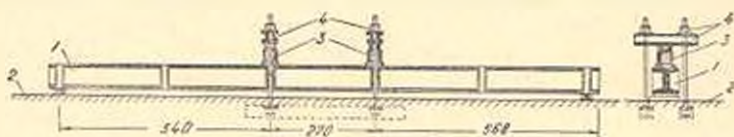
Схема испытания струнотонной балки на изгиб на стенде;
